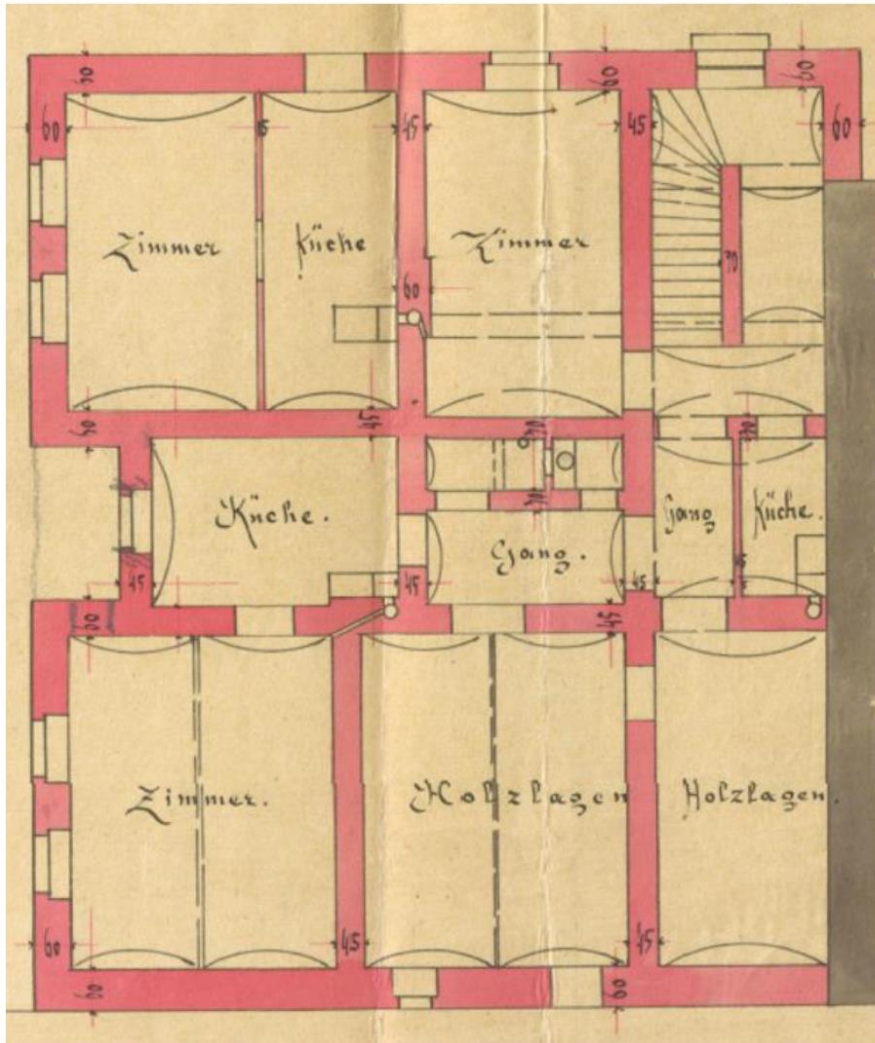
Grundriss eines Mietshauses im Kellergeschoß⁶⁴
